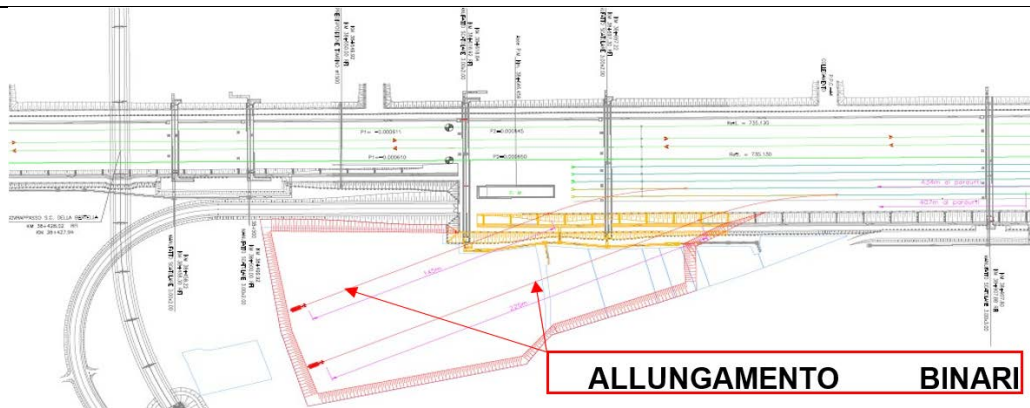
Stralcio progetto di upgrading del piazzale scalo di Alice Castello
